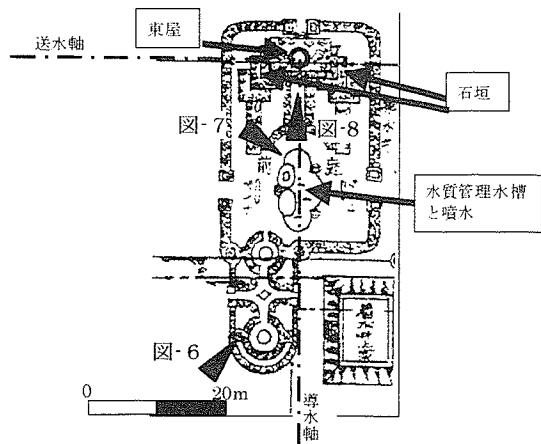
竣工当初の前庭平面図 文献6)に筆者加筆
